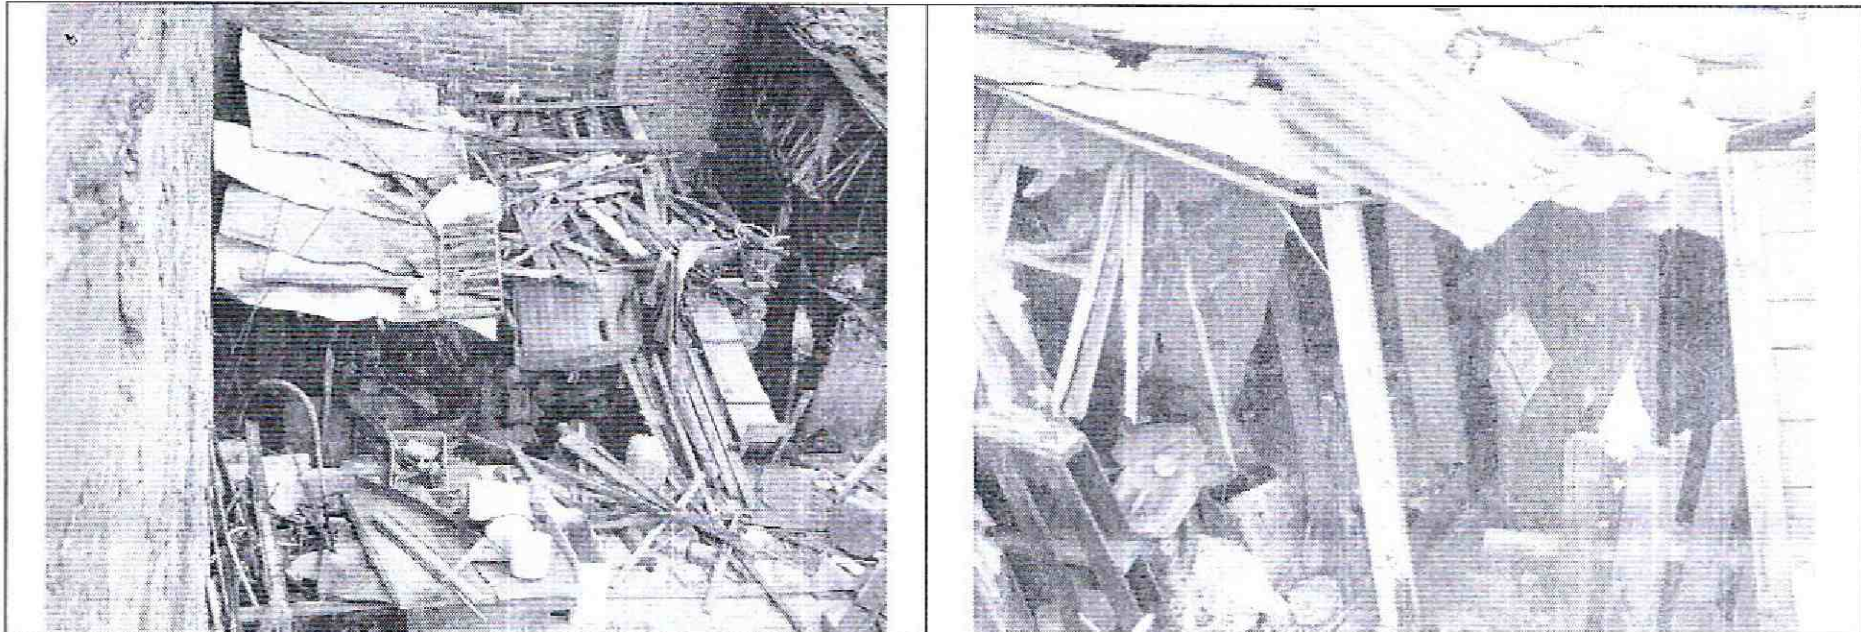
y 10. Izquierda: deformación excesiva de cubierta. Derecha: detalle elementos de soporte cubierta; agrietamiento, desplazamiento de las uniones, deformación excesiva y rompimiento de elementos
